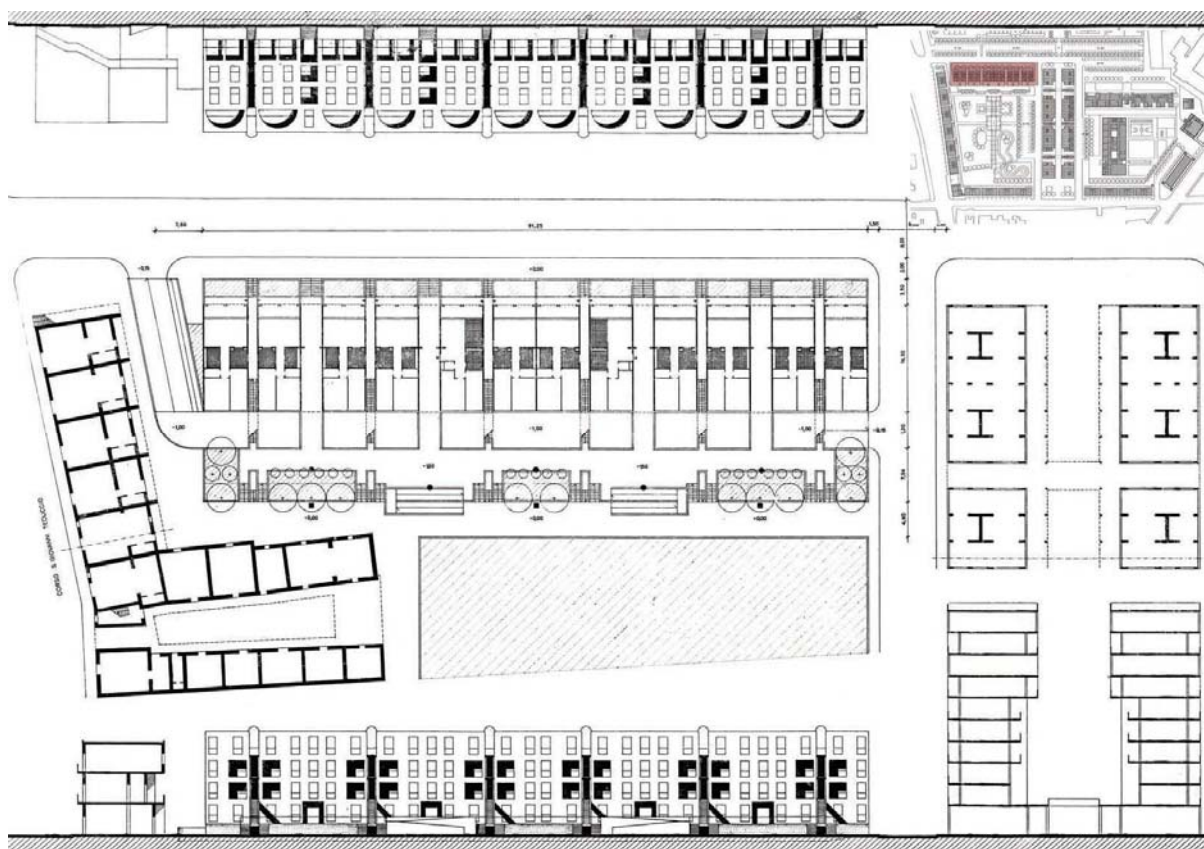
Edilizia bassa realizzata su via Ottaviano con una tipologia riproposta anche a Taverna del Ferro attraverso la realizzazione di alloggi binati serviti da una scala centrale aperta ad unica rampa
